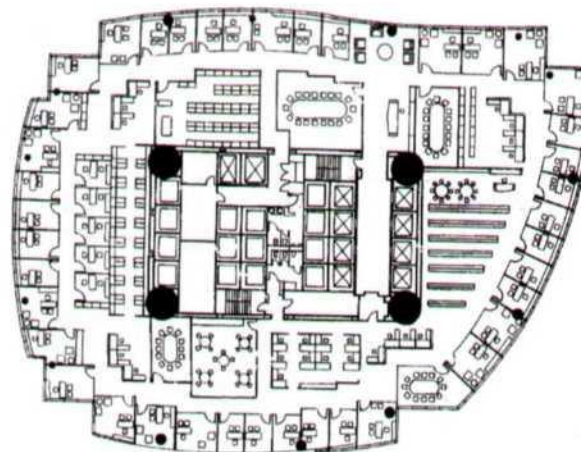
58-поверхова висотна будівля «Two Union Square»
